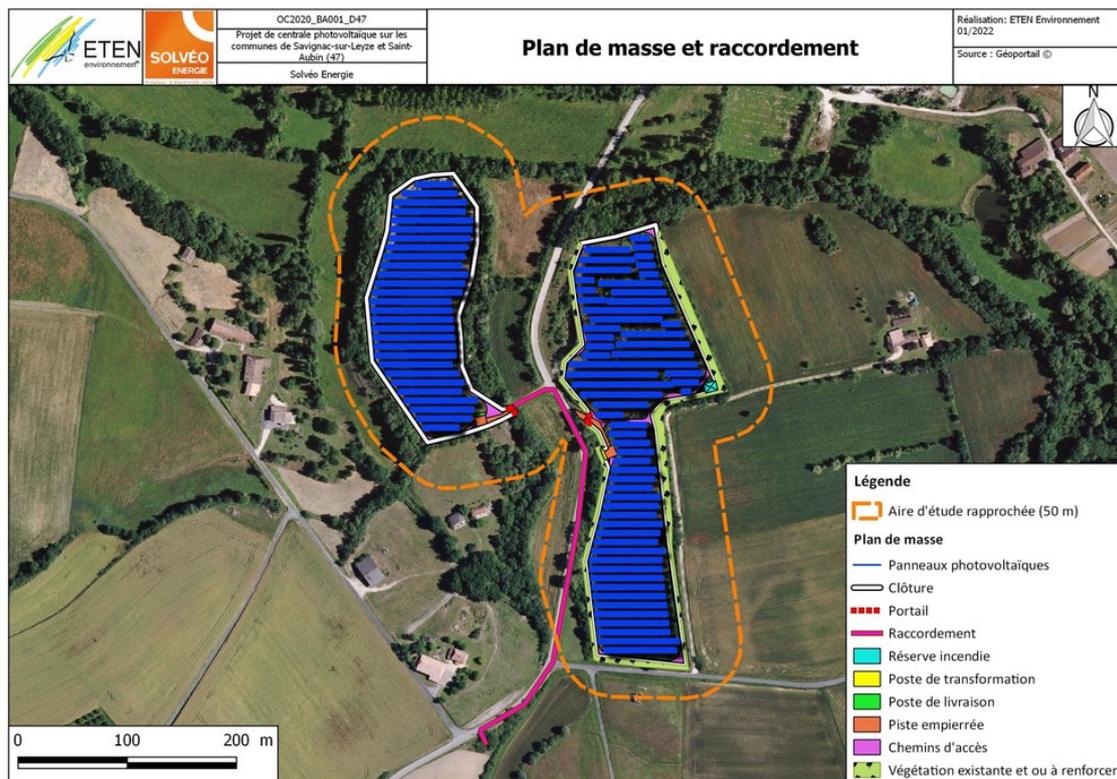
Plan de masse et raccordement du projet photovoltaïque (source : page 20)
